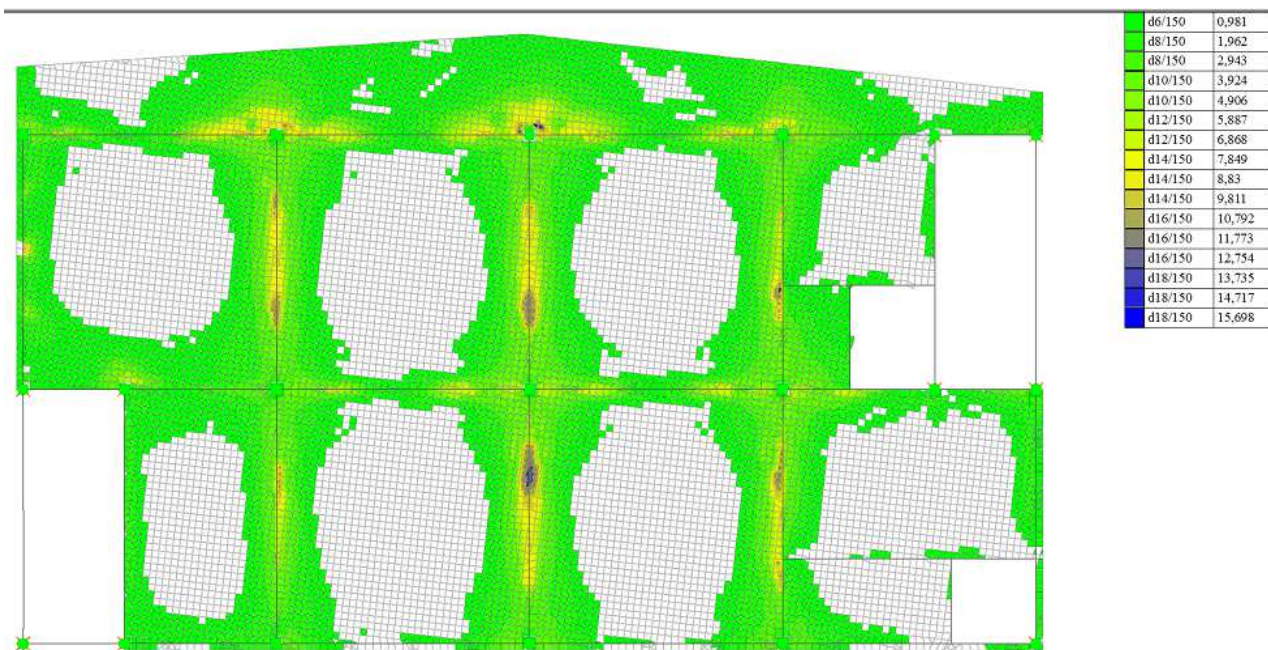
Схема верхнего армирования плиты по оси x
